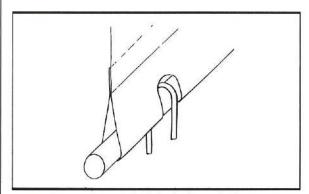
Tubo en borde doblado, detalle standard para estructuras neumáticas.
